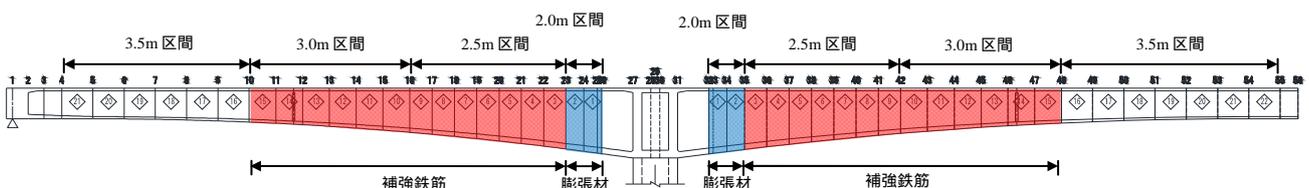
張出し施工部のひび割れ抑制対策
